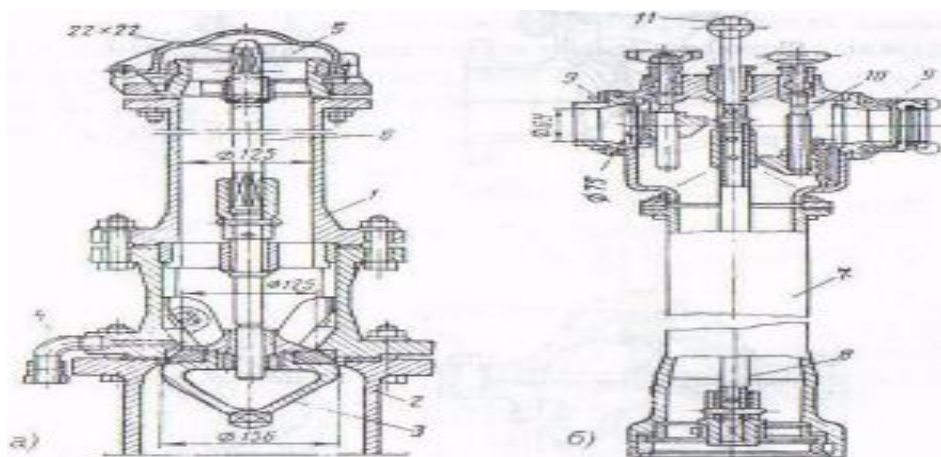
Конструкція пожежного гідранта і стендера: а — пожежний гідрант; б — стендер: 1 — стаяк; 2 — пожежна підставка; 3 — клапан; 4 — штанга з квадратною голівкою; 5 — спускний пристрій; б — ковпак; 7 — корпус стендера; 8 — штанга стендера з квадратною голівкою; 9 — штуцер для під'єднаних пожежного рукава; 10 — запірний
